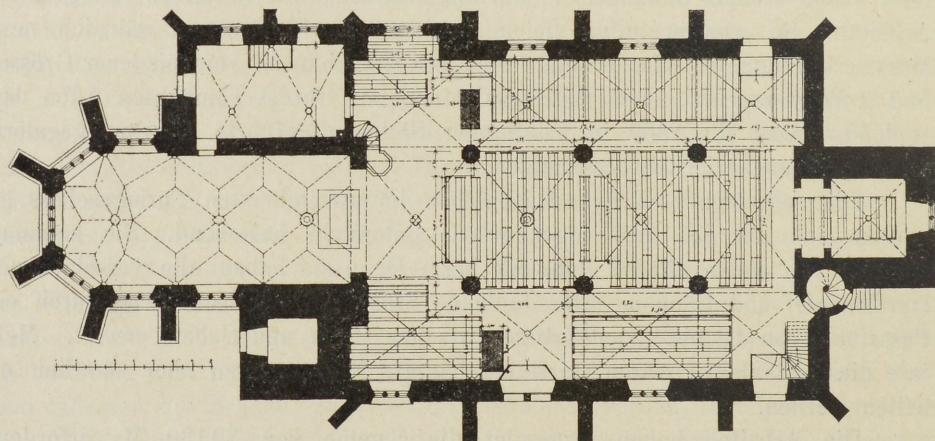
Söbernheim. Grundriss der evangel. Pfarrkirche.
